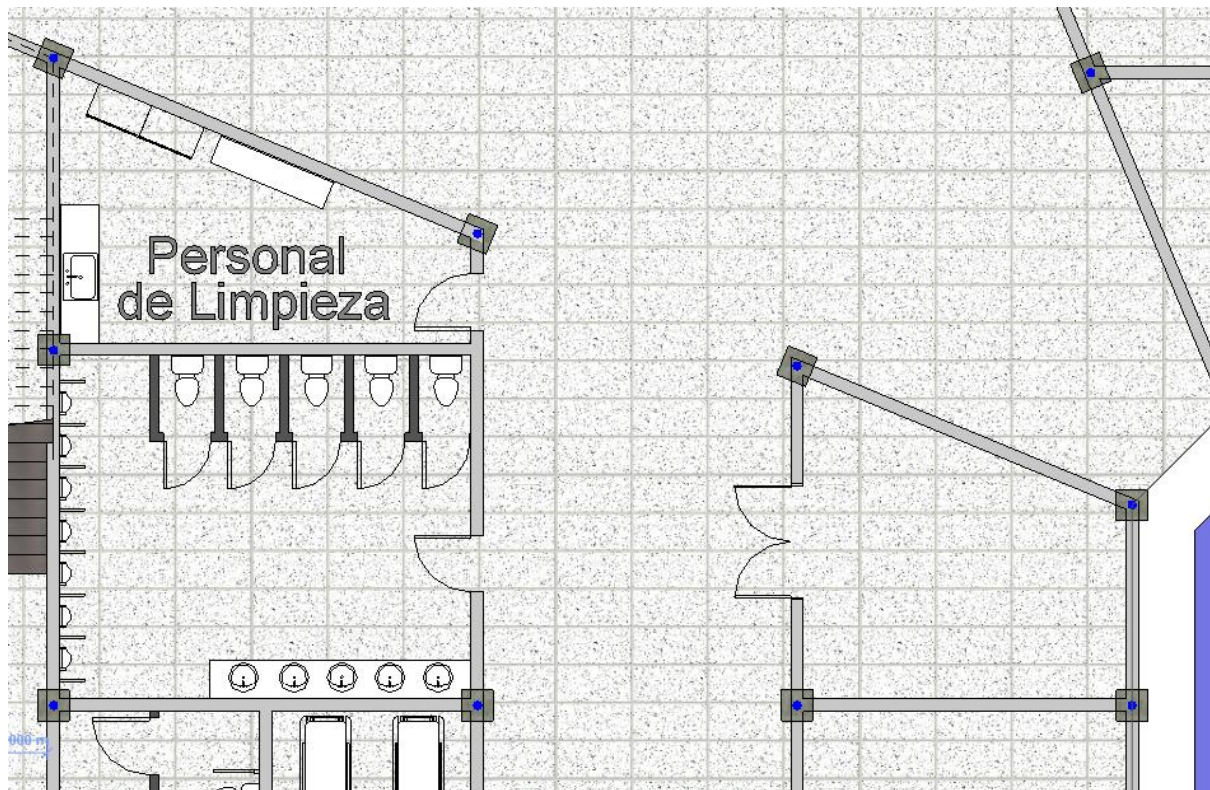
Vista en planta del sector de limpieza. Fuente: elaboración propia.
